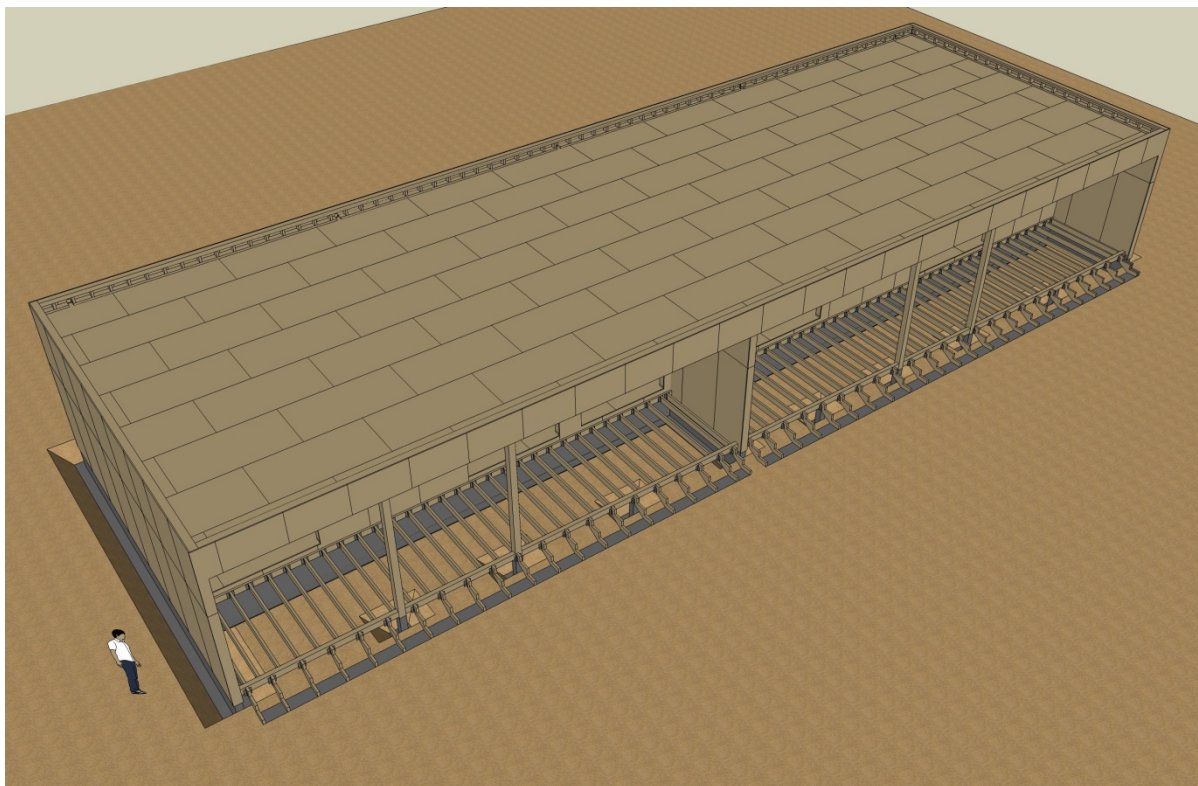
Montagem das vigotas do pavimento do alpendre e pernas.
